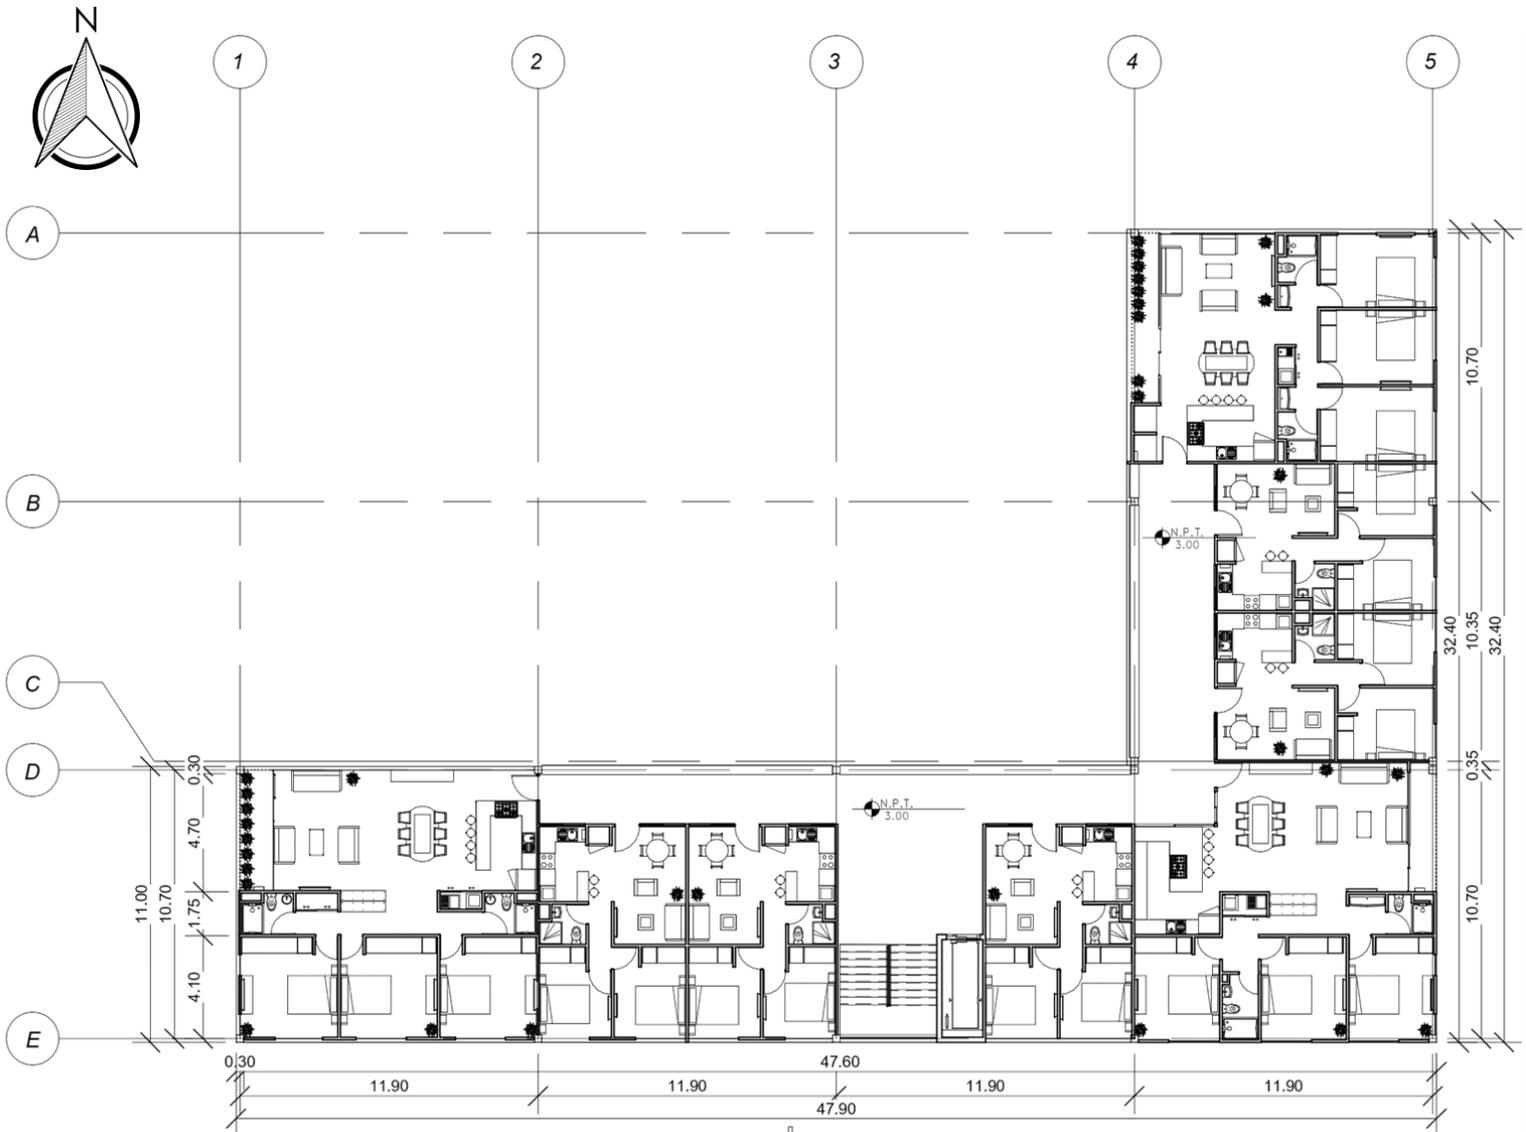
Propuesta final. Planta tipo. Elaboración propia. 2022
